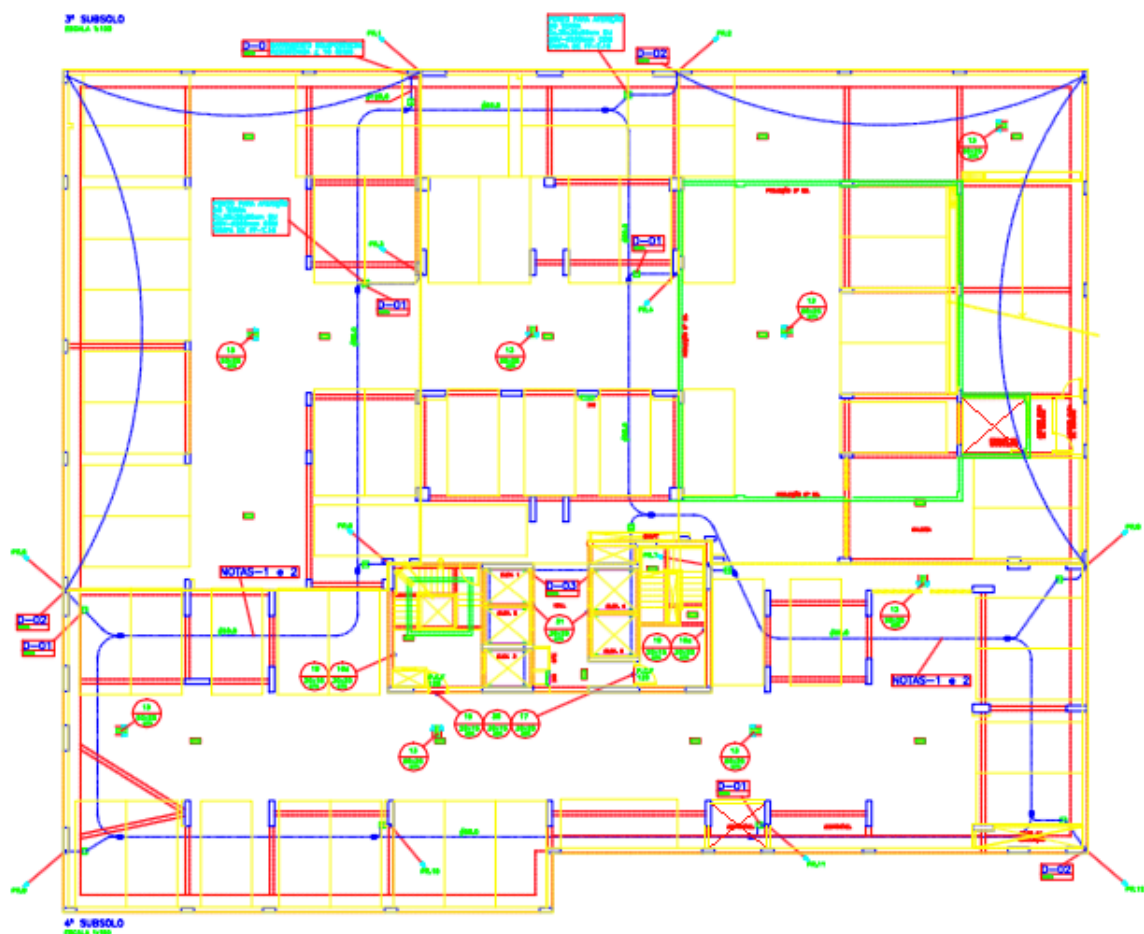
Sugestão de reformulação de projeto para malha do 4º subsolo (e pavimentos até o Pilotis)
